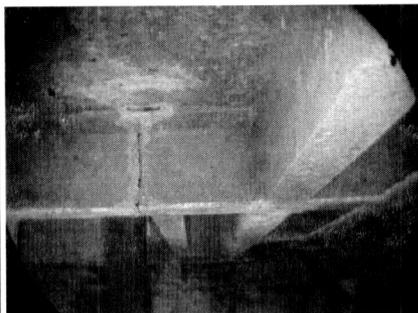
Трещина в сварном соединении консоли перекрытия нижнего балкона
